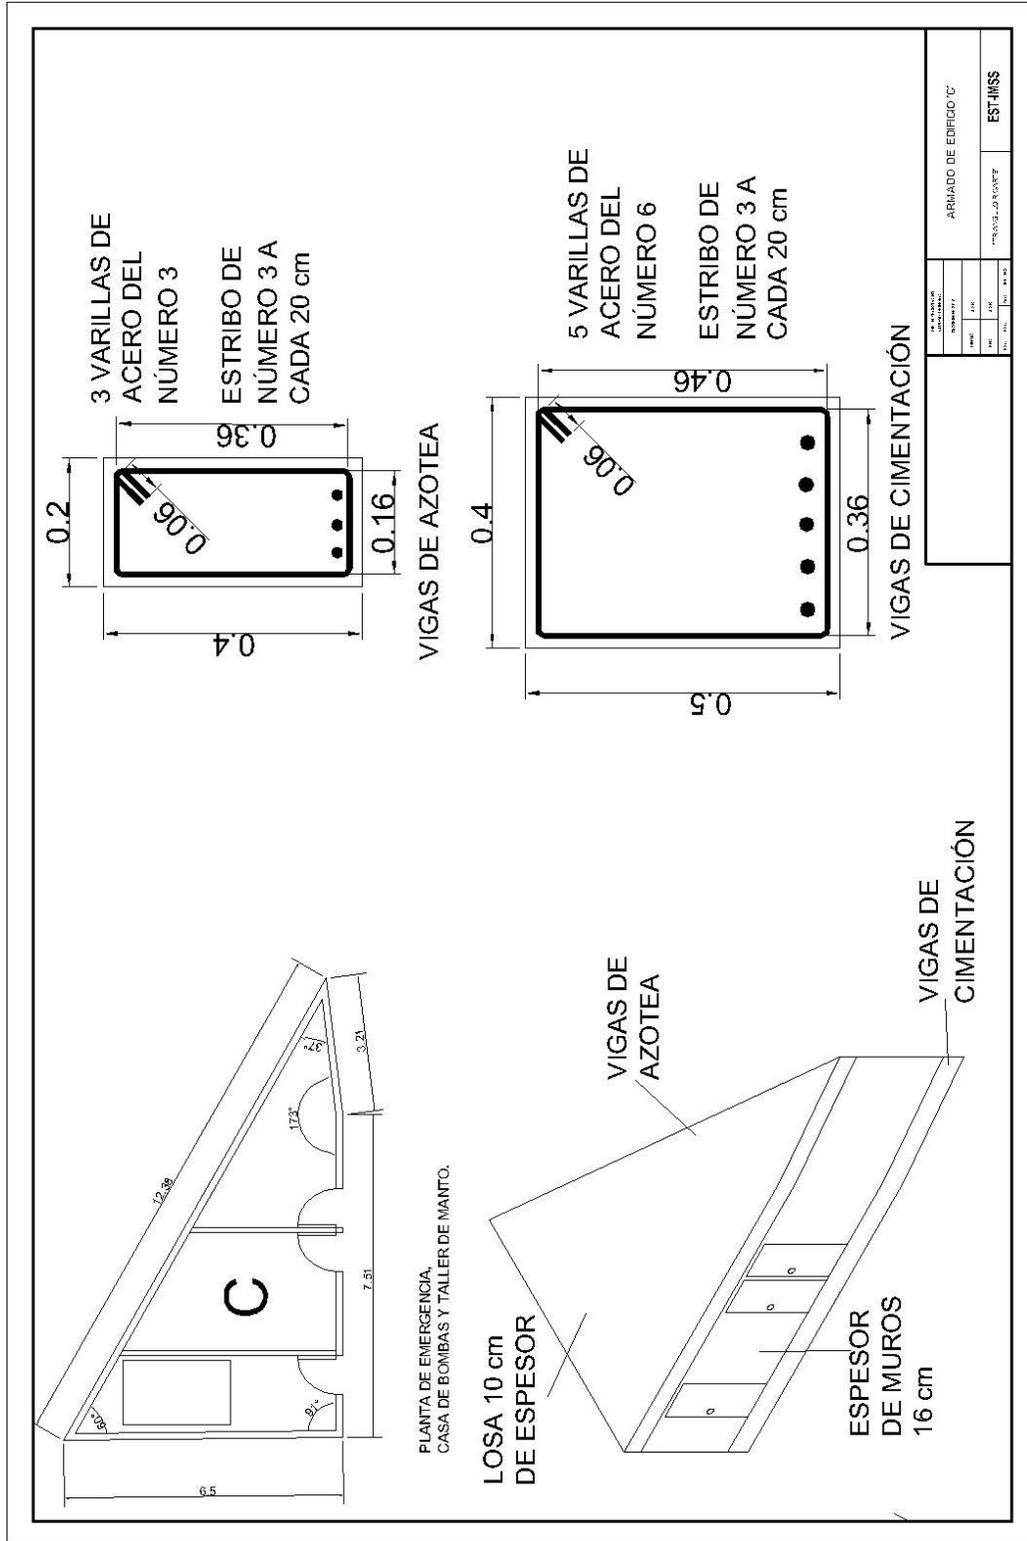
Plano de vigas de edificio "C" (fuente: dibujo hecho por el autor).
